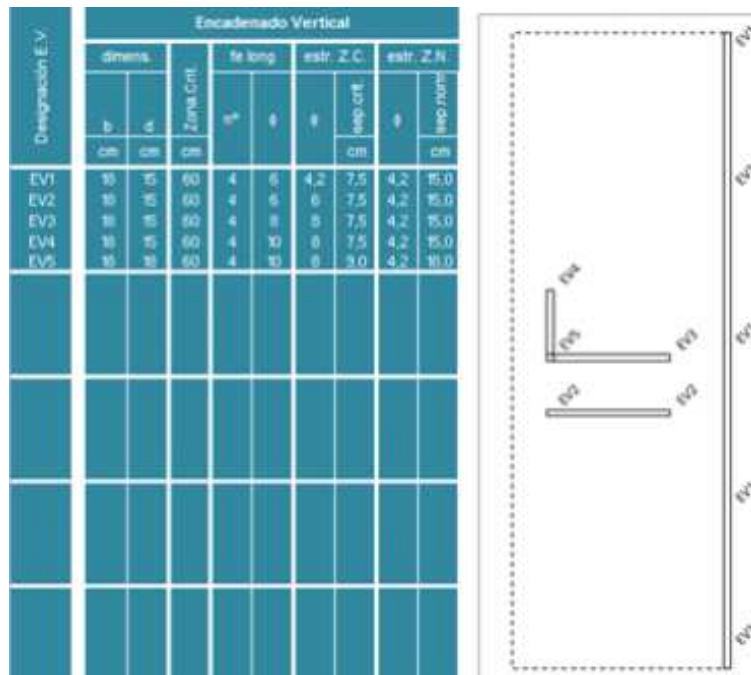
Sección, armadura y ubicación de encadenados verticales
